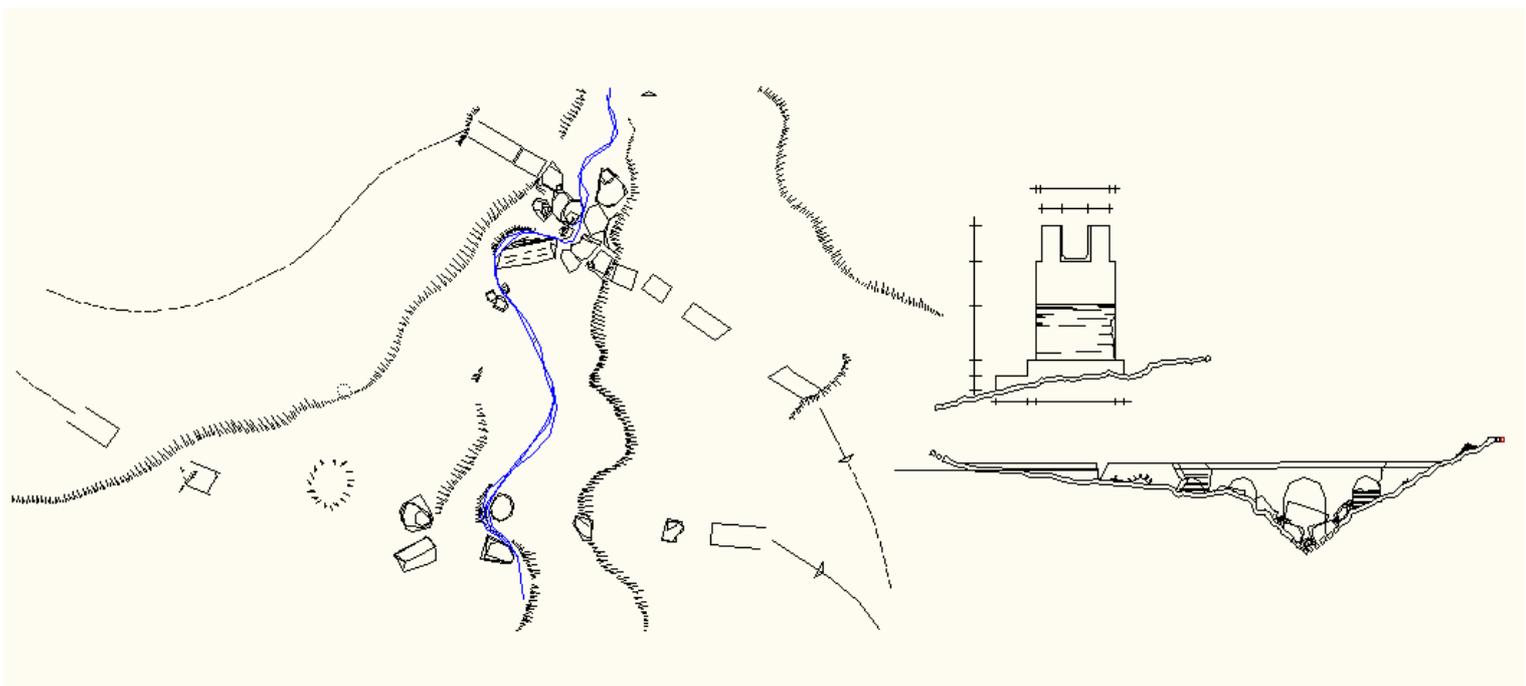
plan coupe sur le pont de l'oued Bouchaoun
